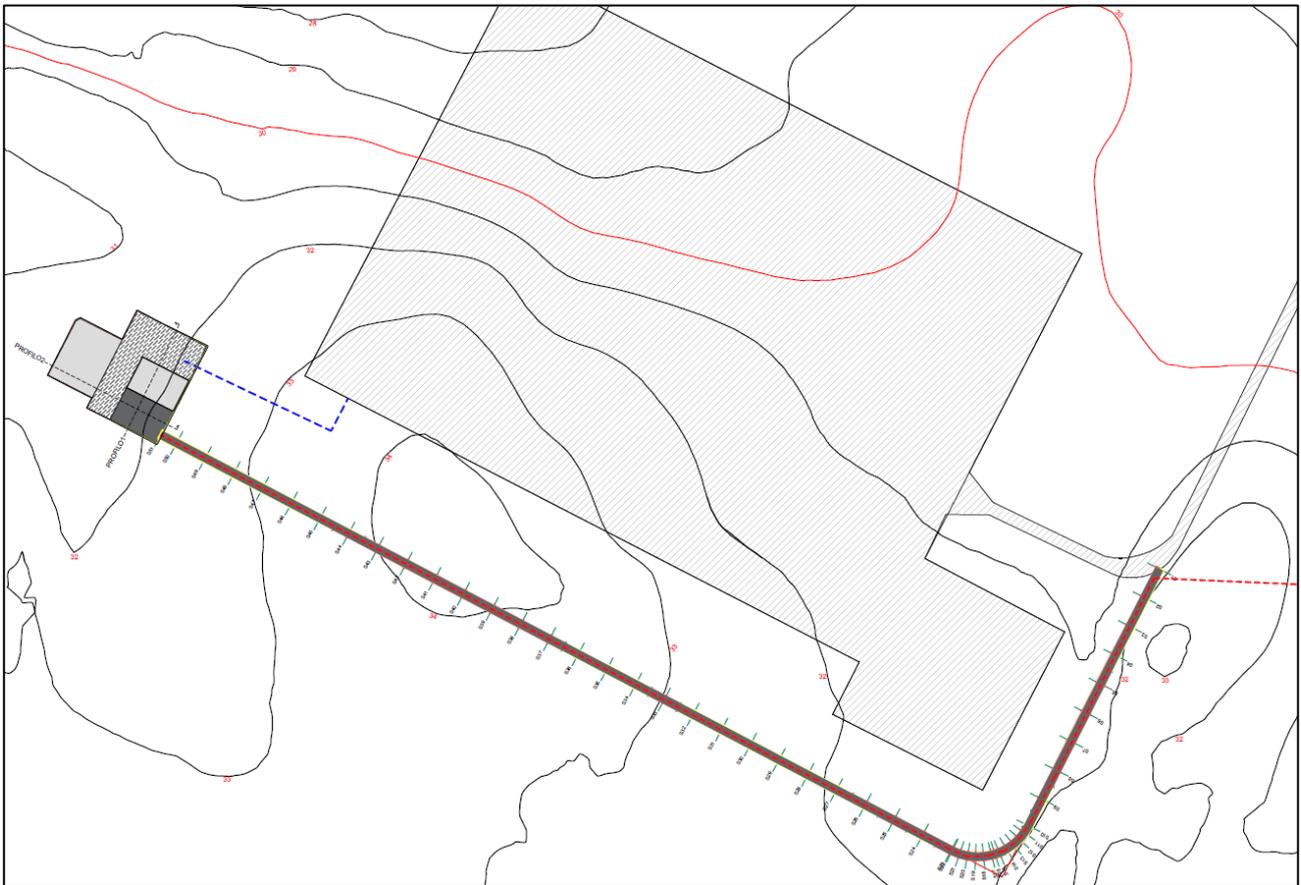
Stralcio planimetrico viabilità di accesso alla SE utente
